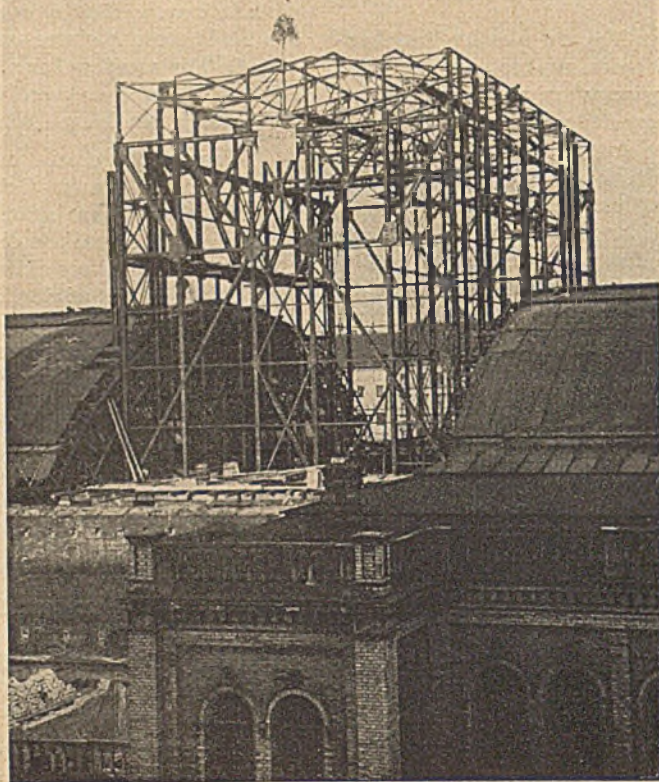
Die Stahlkonstruktion des großen Bühnenhauses, das alte Dach überragend.
